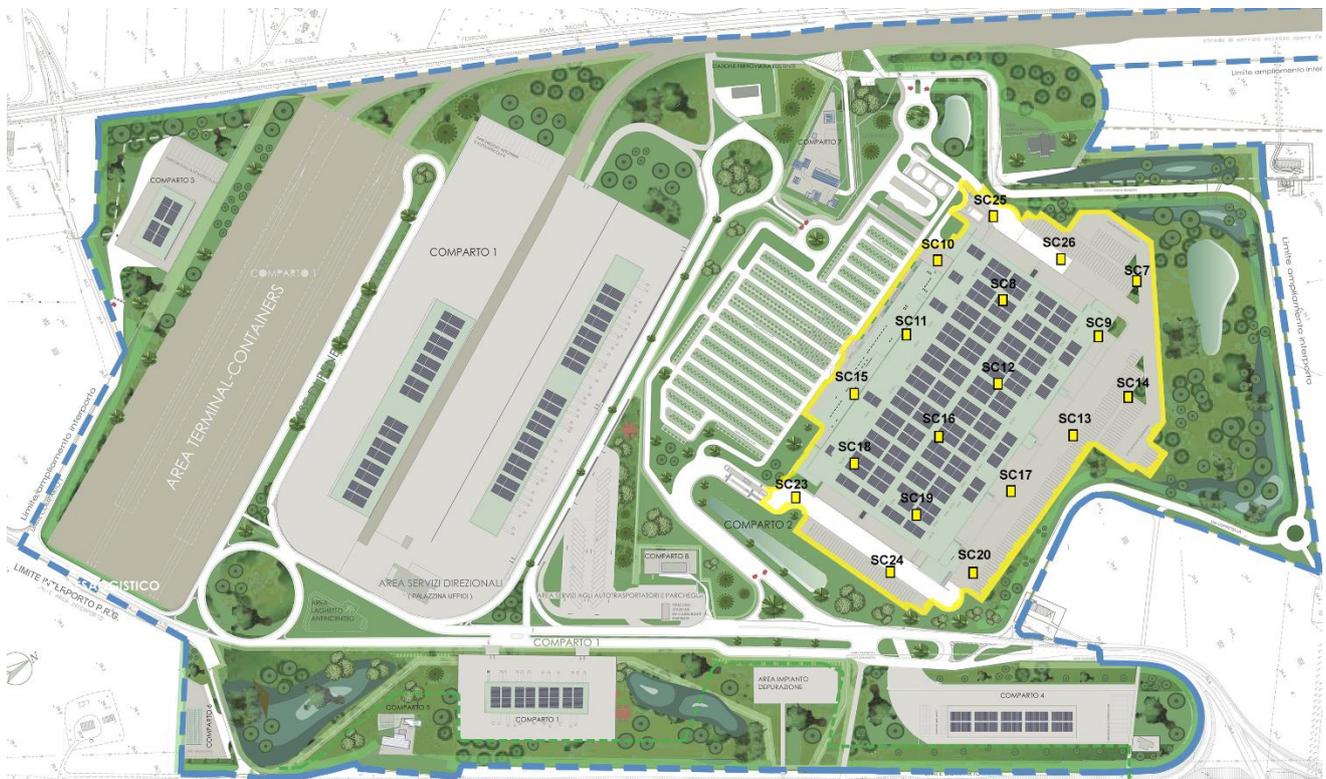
Planimetria con evidenziata la sagoma del capannone in progetto e l'ubicazione dei campionamenti
